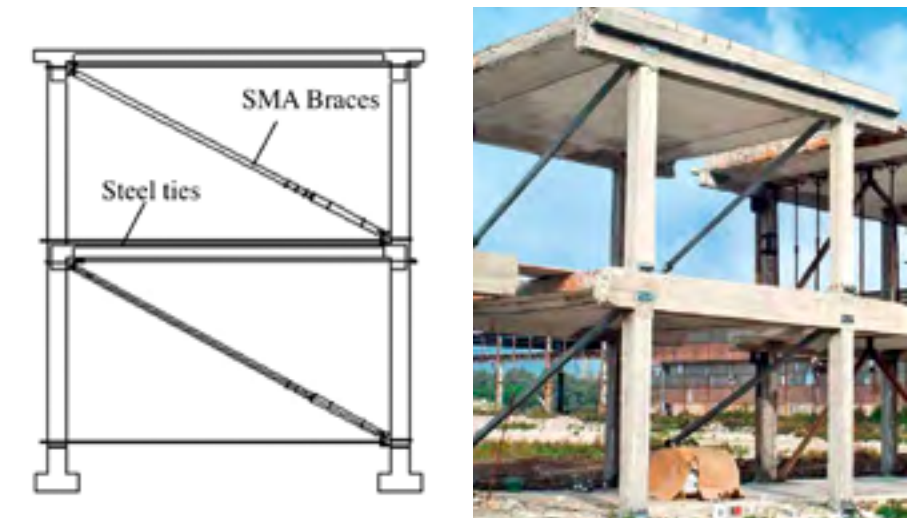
Struttura dell'edificio di prova e vista del telaio trasversale rinforzato con i controventi dissipativi basati sulle LMF (Progetto ILVA-IDEM).
